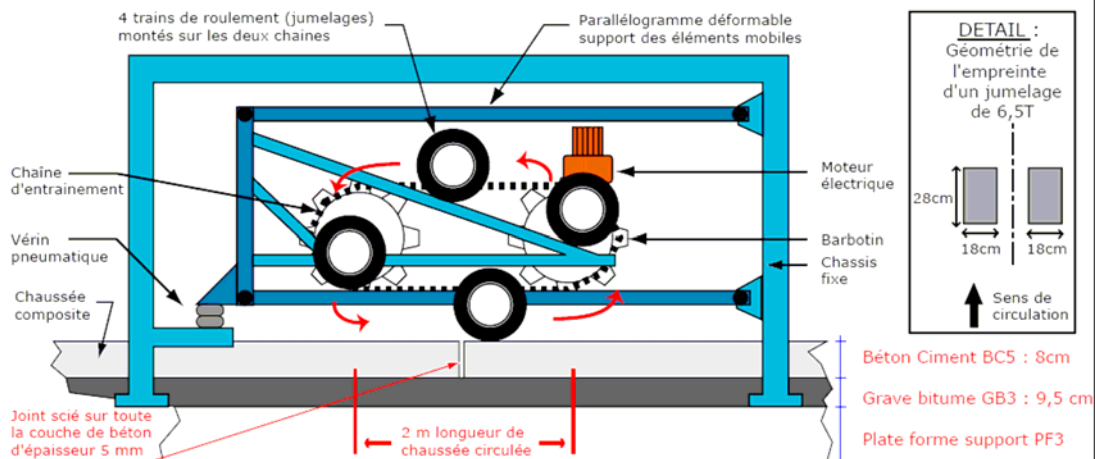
Schéma du principe de l'essai sur un joint d'une structure type BCMC
